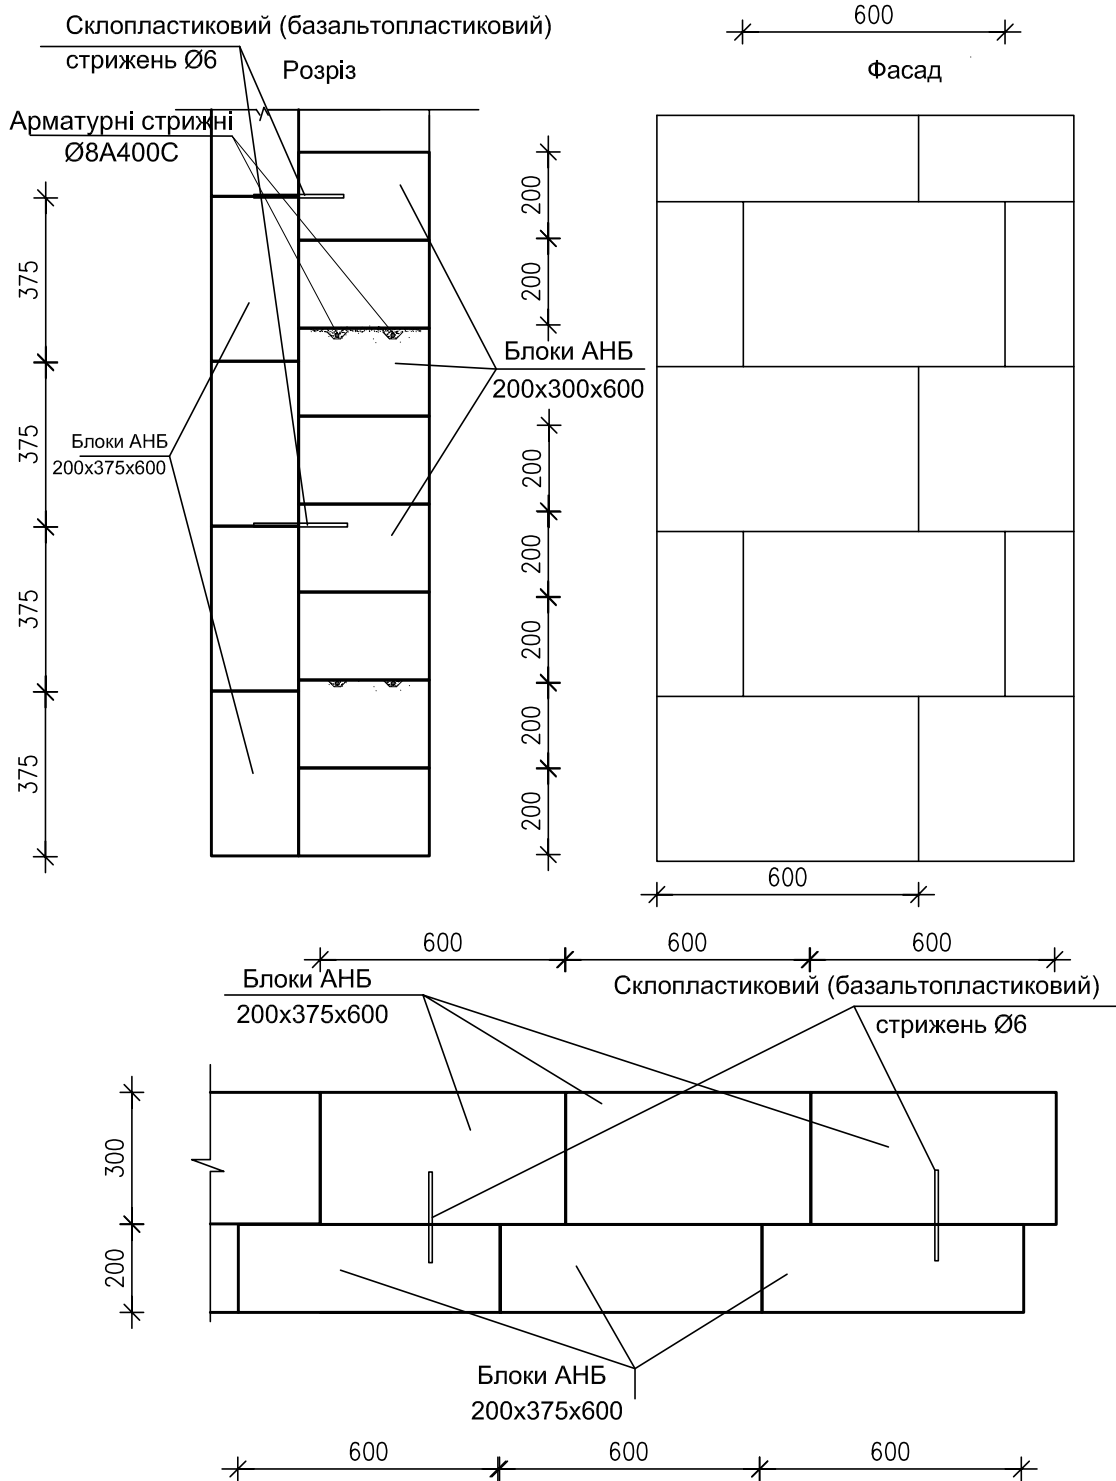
Двошарова стіна першого типу. Фрагмент глухої стіни.
